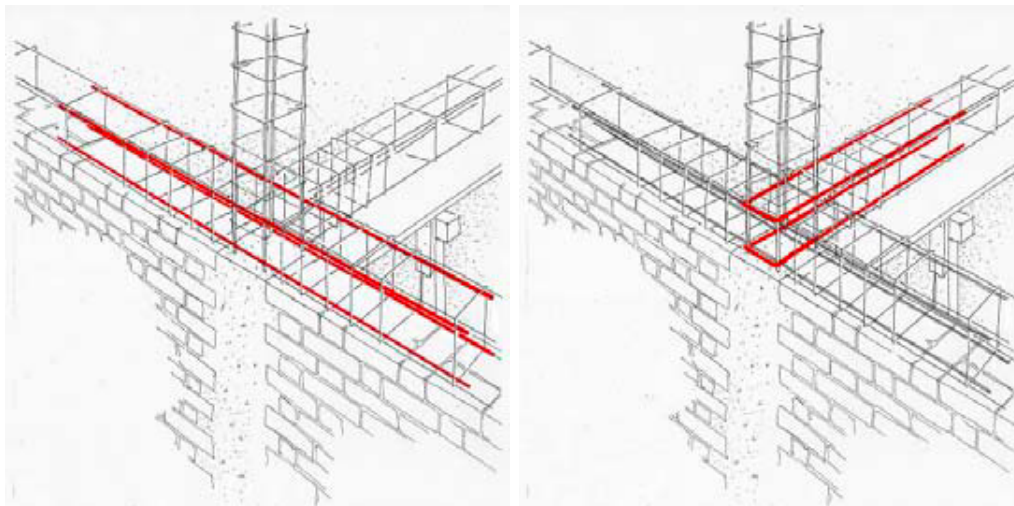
Detalle de las barras de refuerzo en el encuentro de muros en T (Schacher, 2006)
